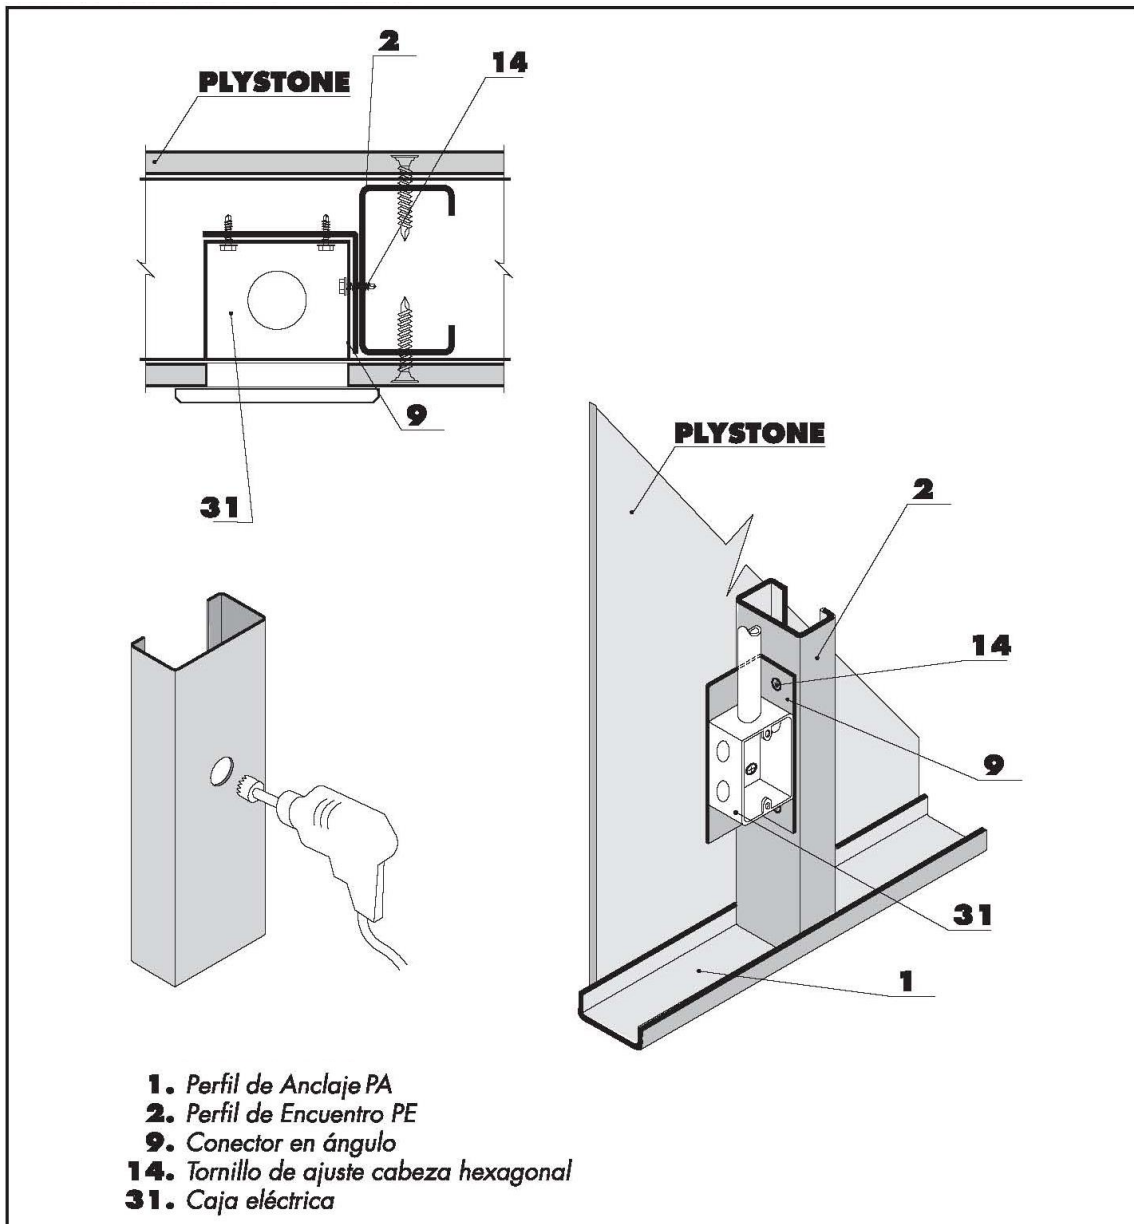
Detalle 18. Paredes exteriores. Instalaciones eléctricas [87].
